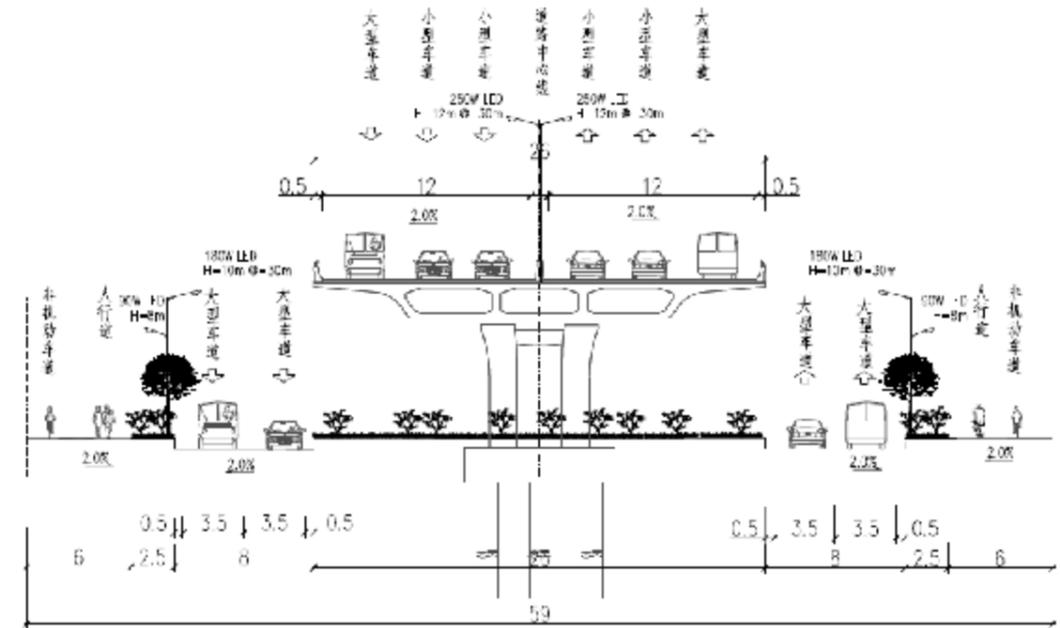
金沙西路西延（K0+000-K1+140）照明横断面图（尺寸单位：m）
